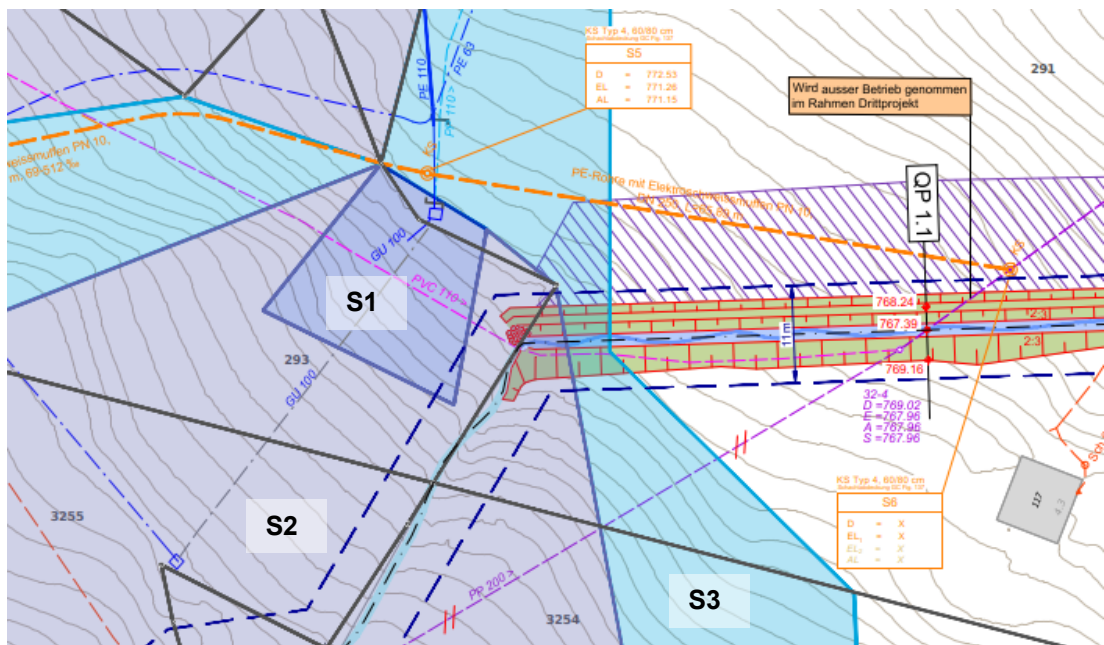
Tangierte Grundwasserschutzzonen (Plan-Nr. 505.5-A.210)
